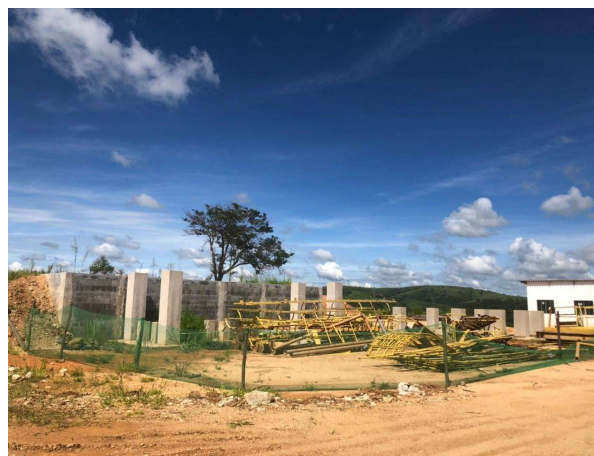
Situação atual das Estruturas no Canteiro operacional (18/01/2021)
